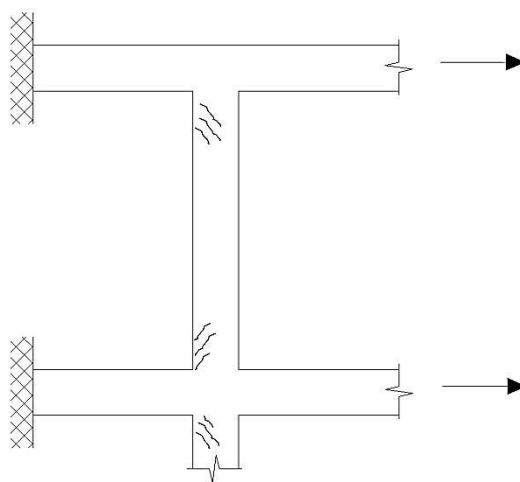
Fissuras por dilatação térmica das vigas
